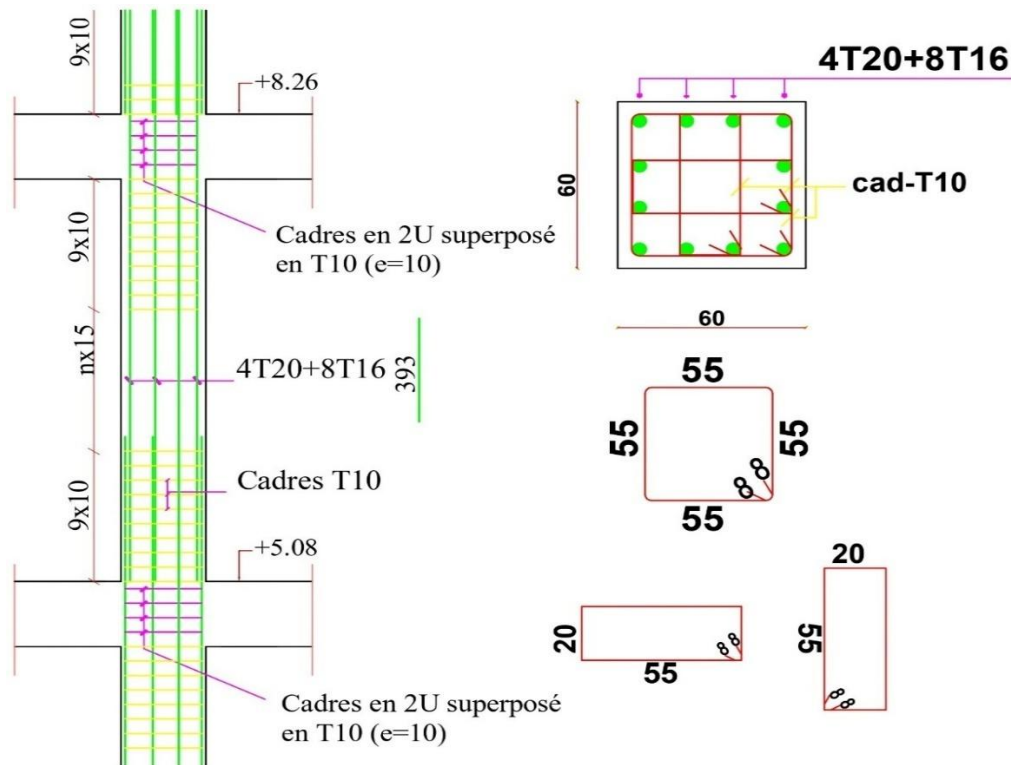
Schéma de ferrailage du poteau (60x60)
